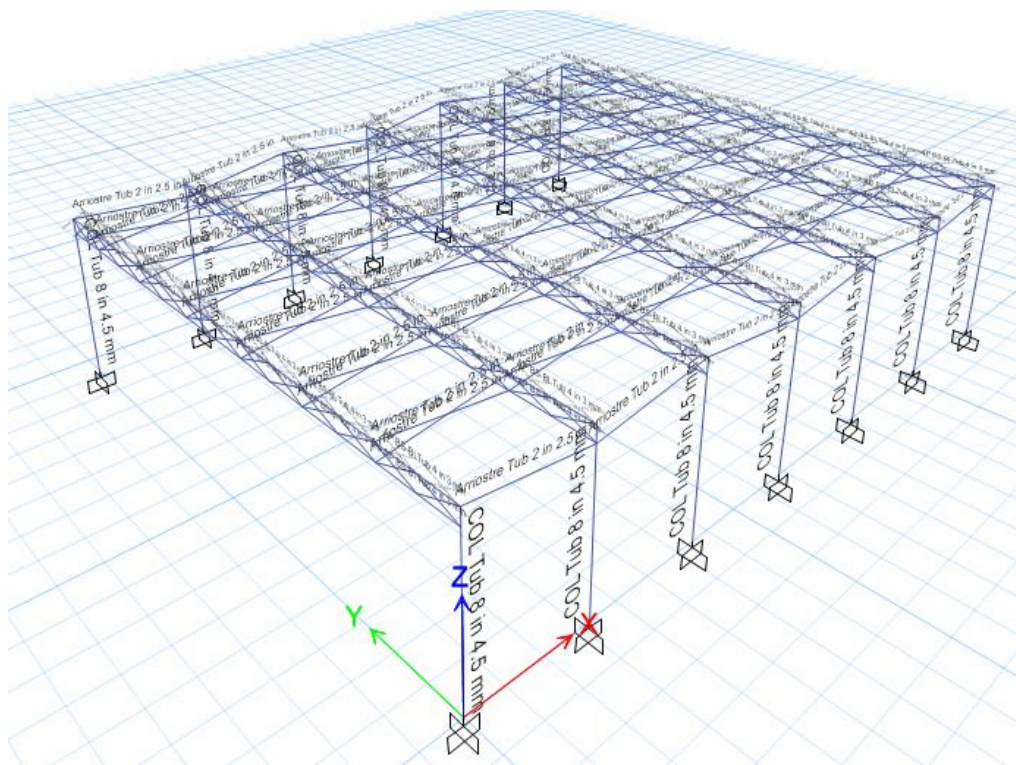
Definición de secciones de la estructura en ejemplo. [Fuente: Elaboración propia mediante software “Etabs 2016”]
